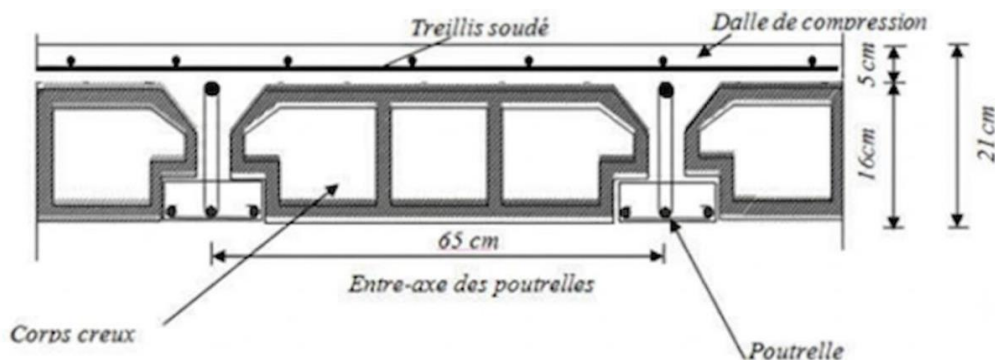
Exemple d'une coupe d'un plancher à corps creux.
